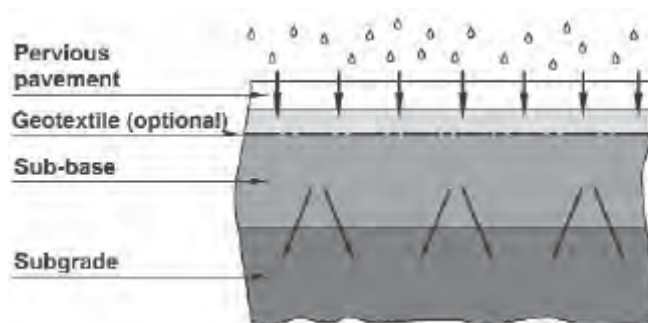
Pavimento poroso Tipo A com infiltração total
